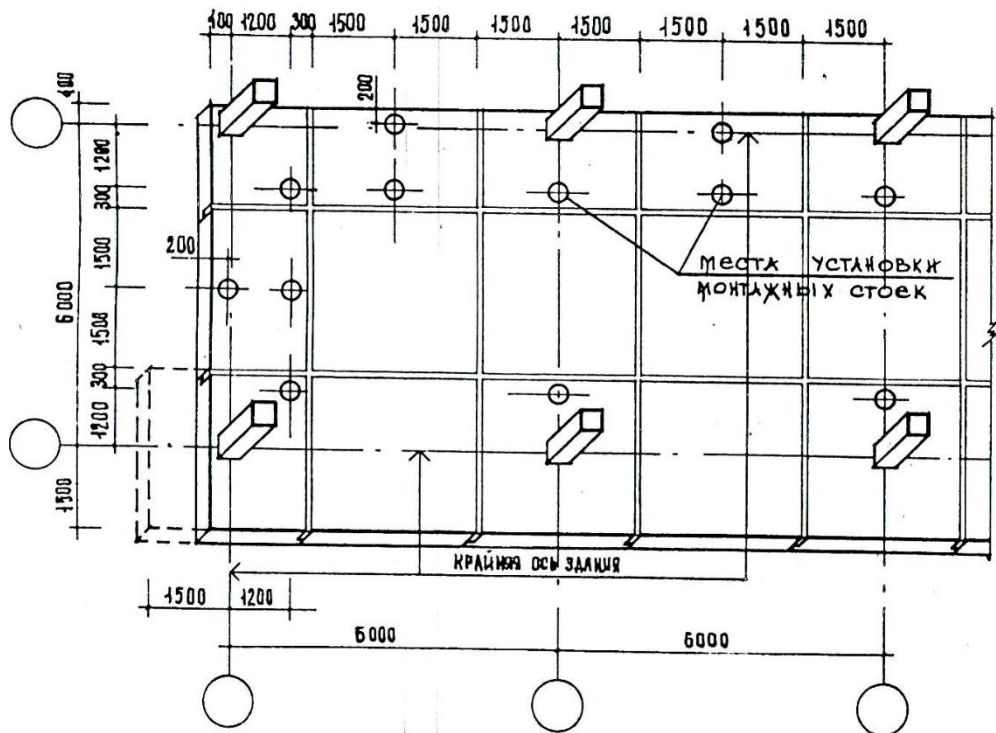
Схема установки стійок під консольними частинами плит по крайніх вісях будинку.
